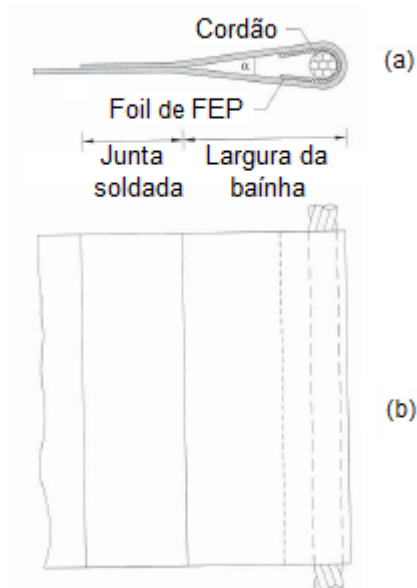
Corte e planta de um bordo com cordão, respectivamente a) e b).
